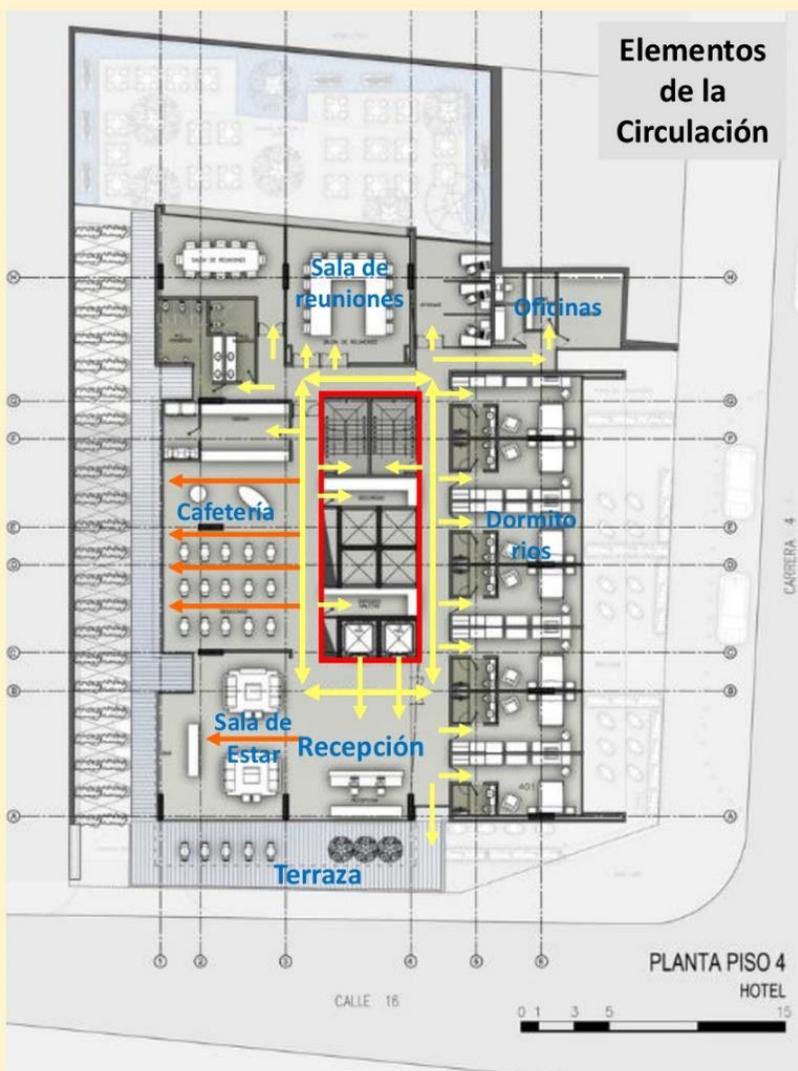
Cuarta Planta escala 1:300 Fuente: www.archdaily.pe
